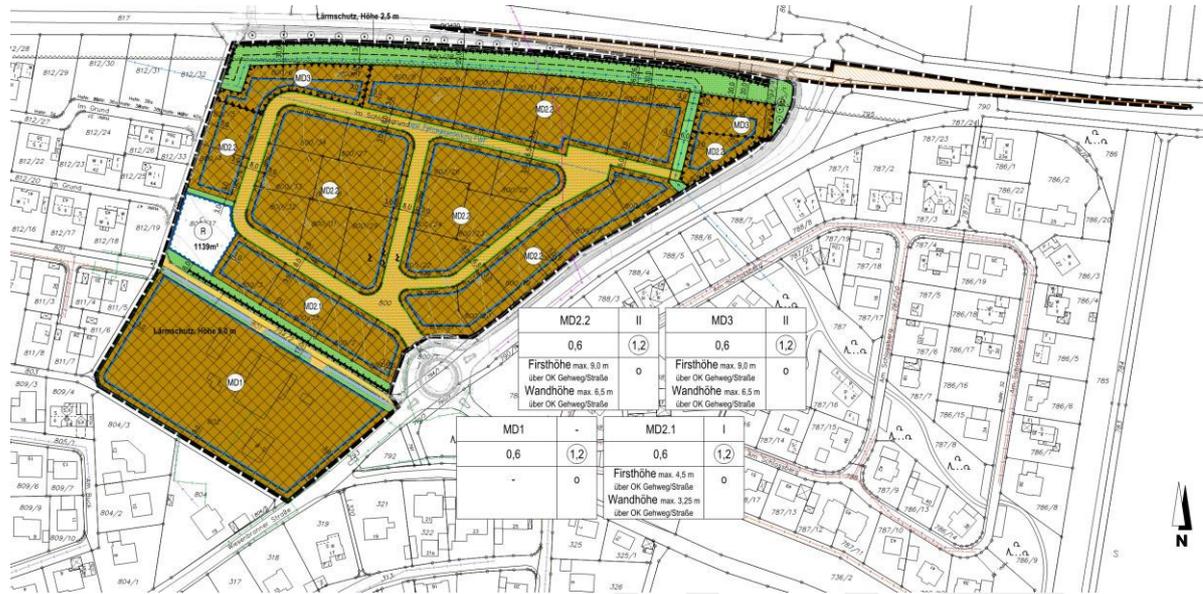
BPlan "Schlossgrund", Planteil mit Nutzungsschablone und möglicher Grundstücksaufteilung. Stand 01.03.2019
